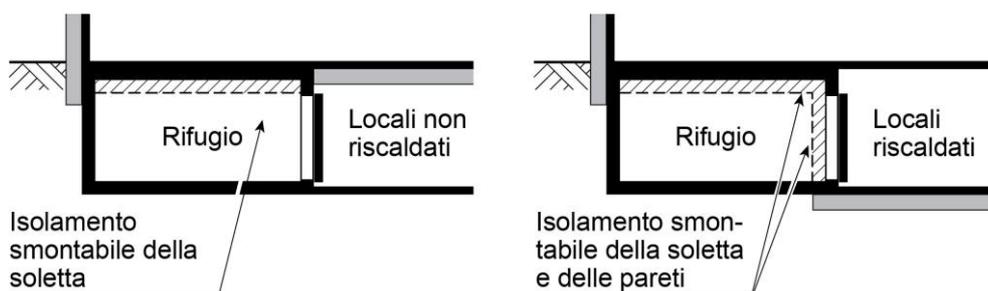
Concetto d'isolamento termico con isolamento perimetrale e isolamento smontabile nel rifugio
